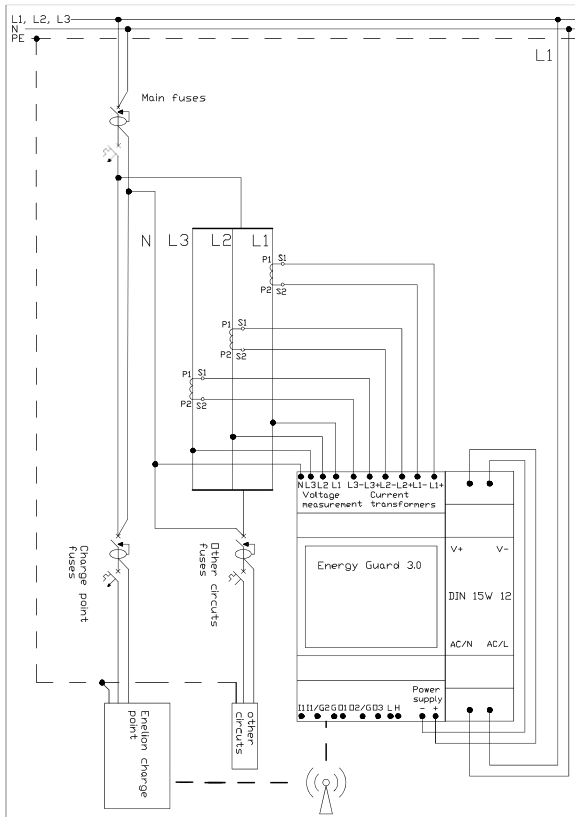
Anschlussplan des EEG zur Messung der Last ohne Ladeklemmen.
